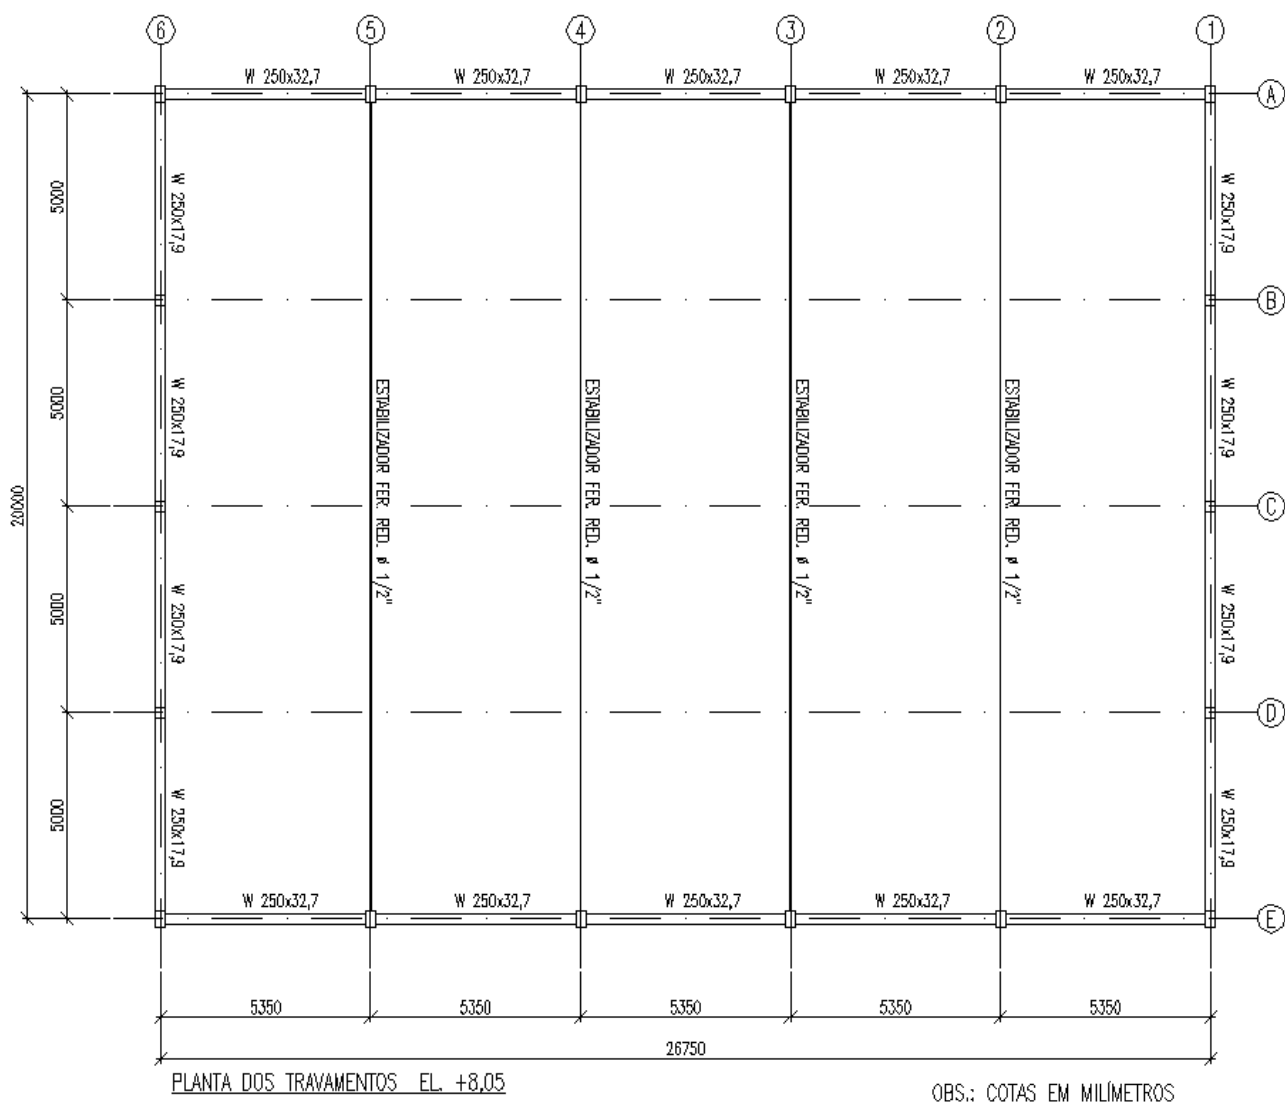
Planta de locação dos travamentos para estrutura metálica.
